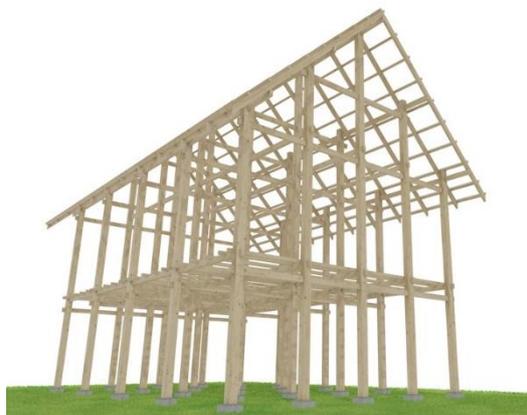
Potongan Melintang Struktur Rumah Panggung dengan Archicad – Struktur bagian bawah
